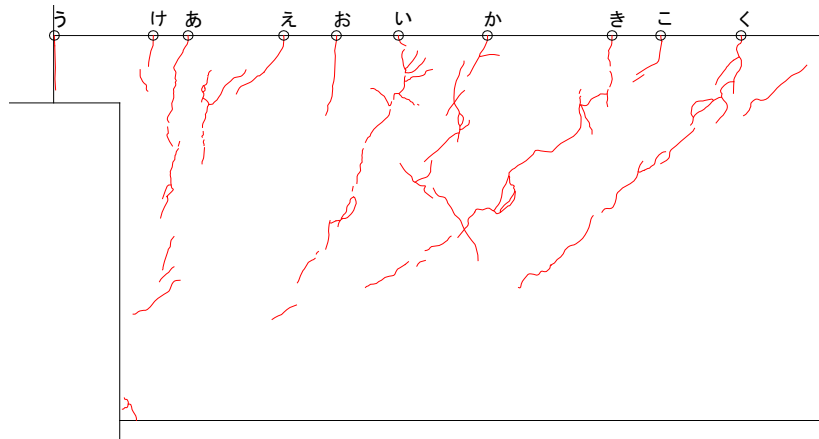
基礎梁ひび割れ幅測定位置(試験体 A-5 負荷荷)
